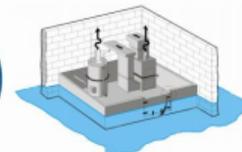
Esquema barrera protección de equipamientos (FEMA)
